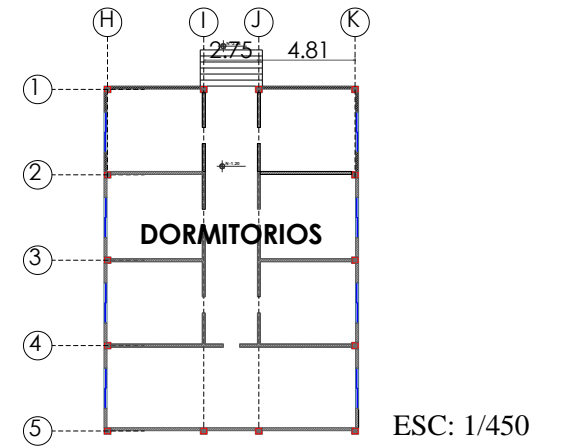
Planta Subterránea 2. Ex Academia Militar Juan Gómez Rendón
